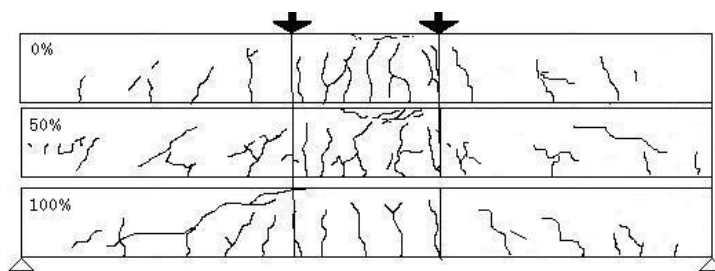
ひび割れ発生状況 ($a/d=4$)
